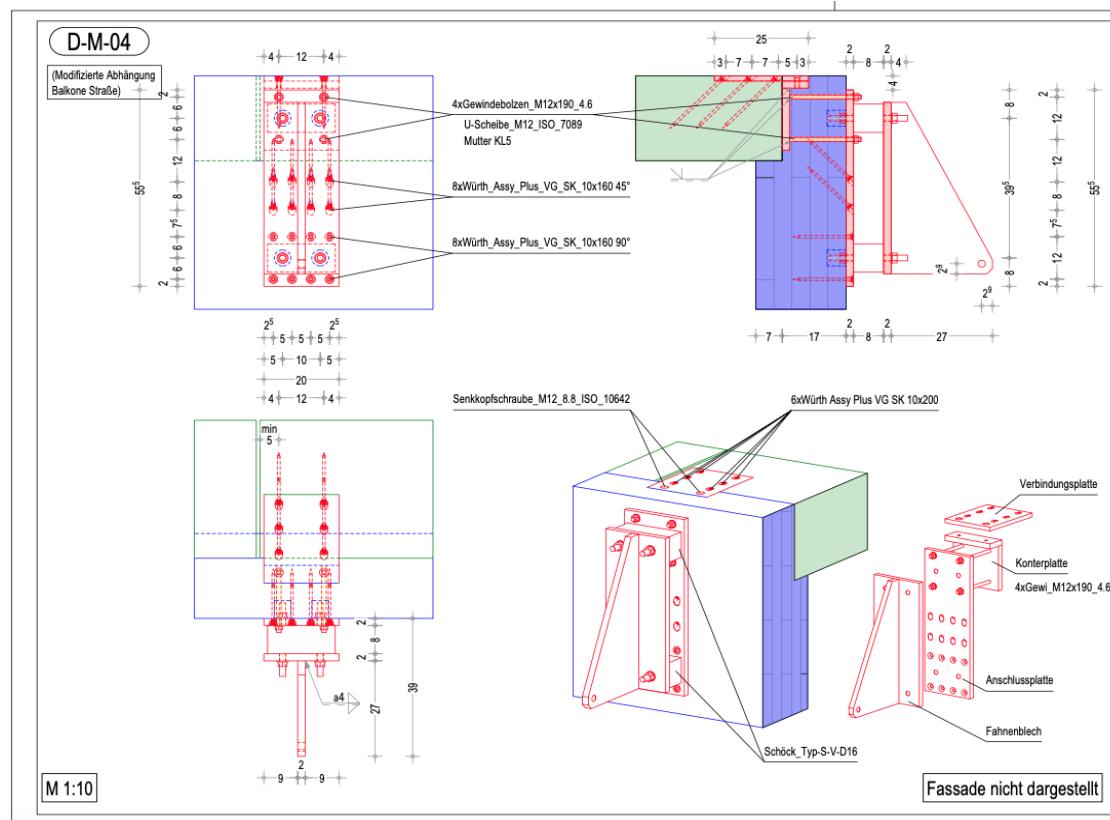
Werkplanung Fassaden, Balkonabhängungen – Verfasser: Prause Holzbauplanung, Lindlar (D)
